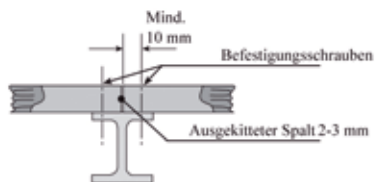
Schraubenabstand von der Plattenkante mind. 10 mm.
